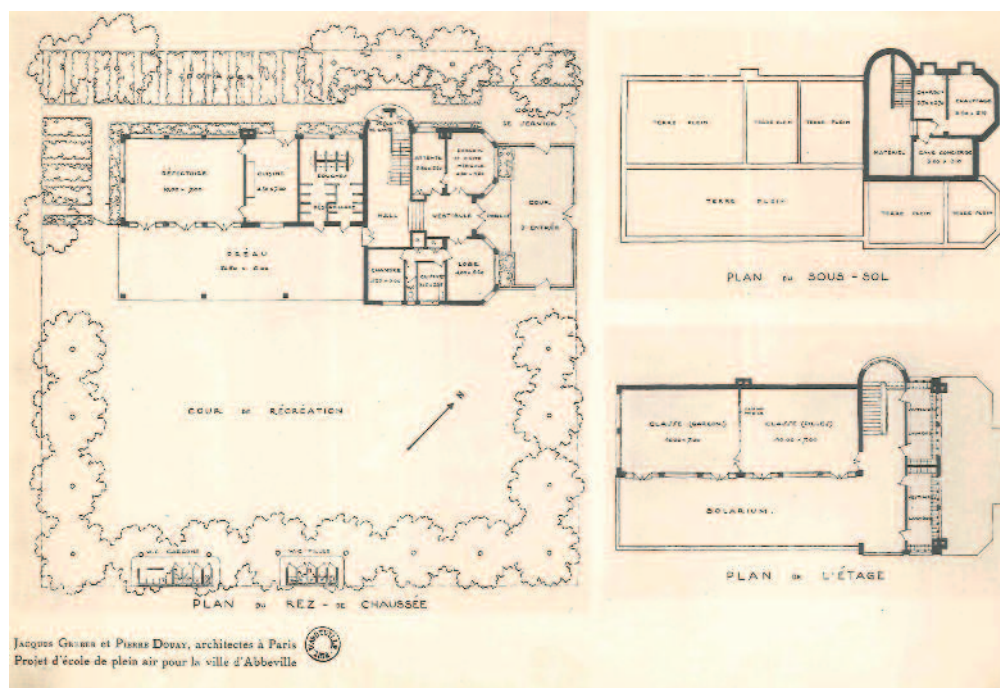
Jacques Gréber et Pierre Douay, projet d'école de plein air pour la ville d'Abbeville, plans de niveaux, photographie du tirage, 1932-1933 | Arch. mun. Abbeville, fonds de la Seconde Guerre mondiale ©Ville d'Abbeville.
